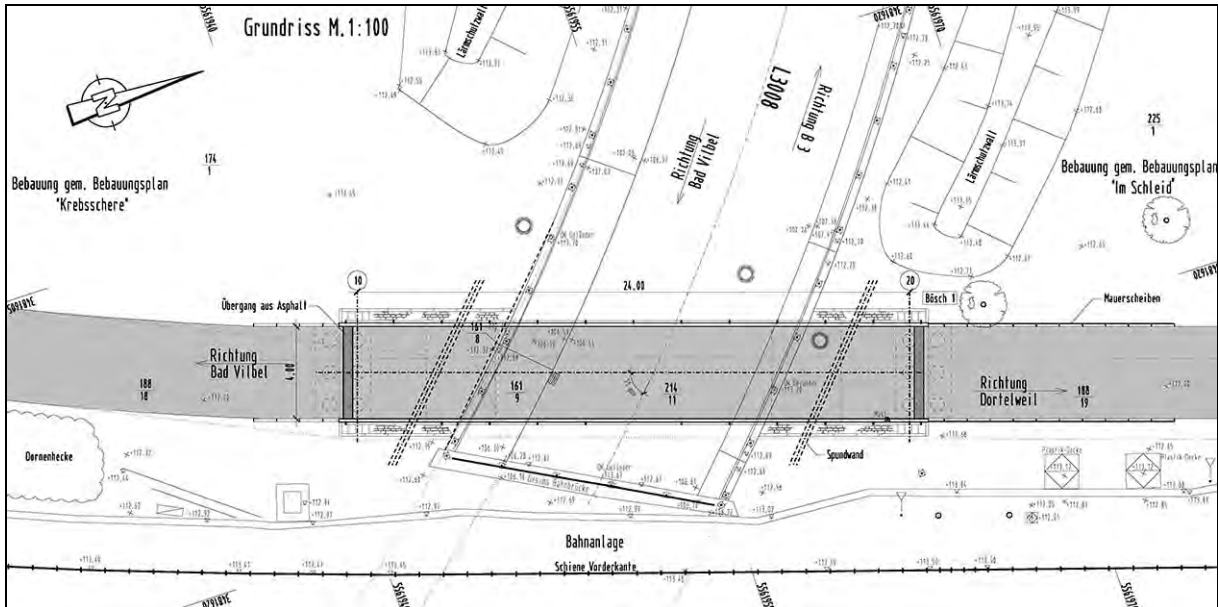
Fuß- und Radwegebrücke über die Nordumgehung L 3008 (Grundriss)
